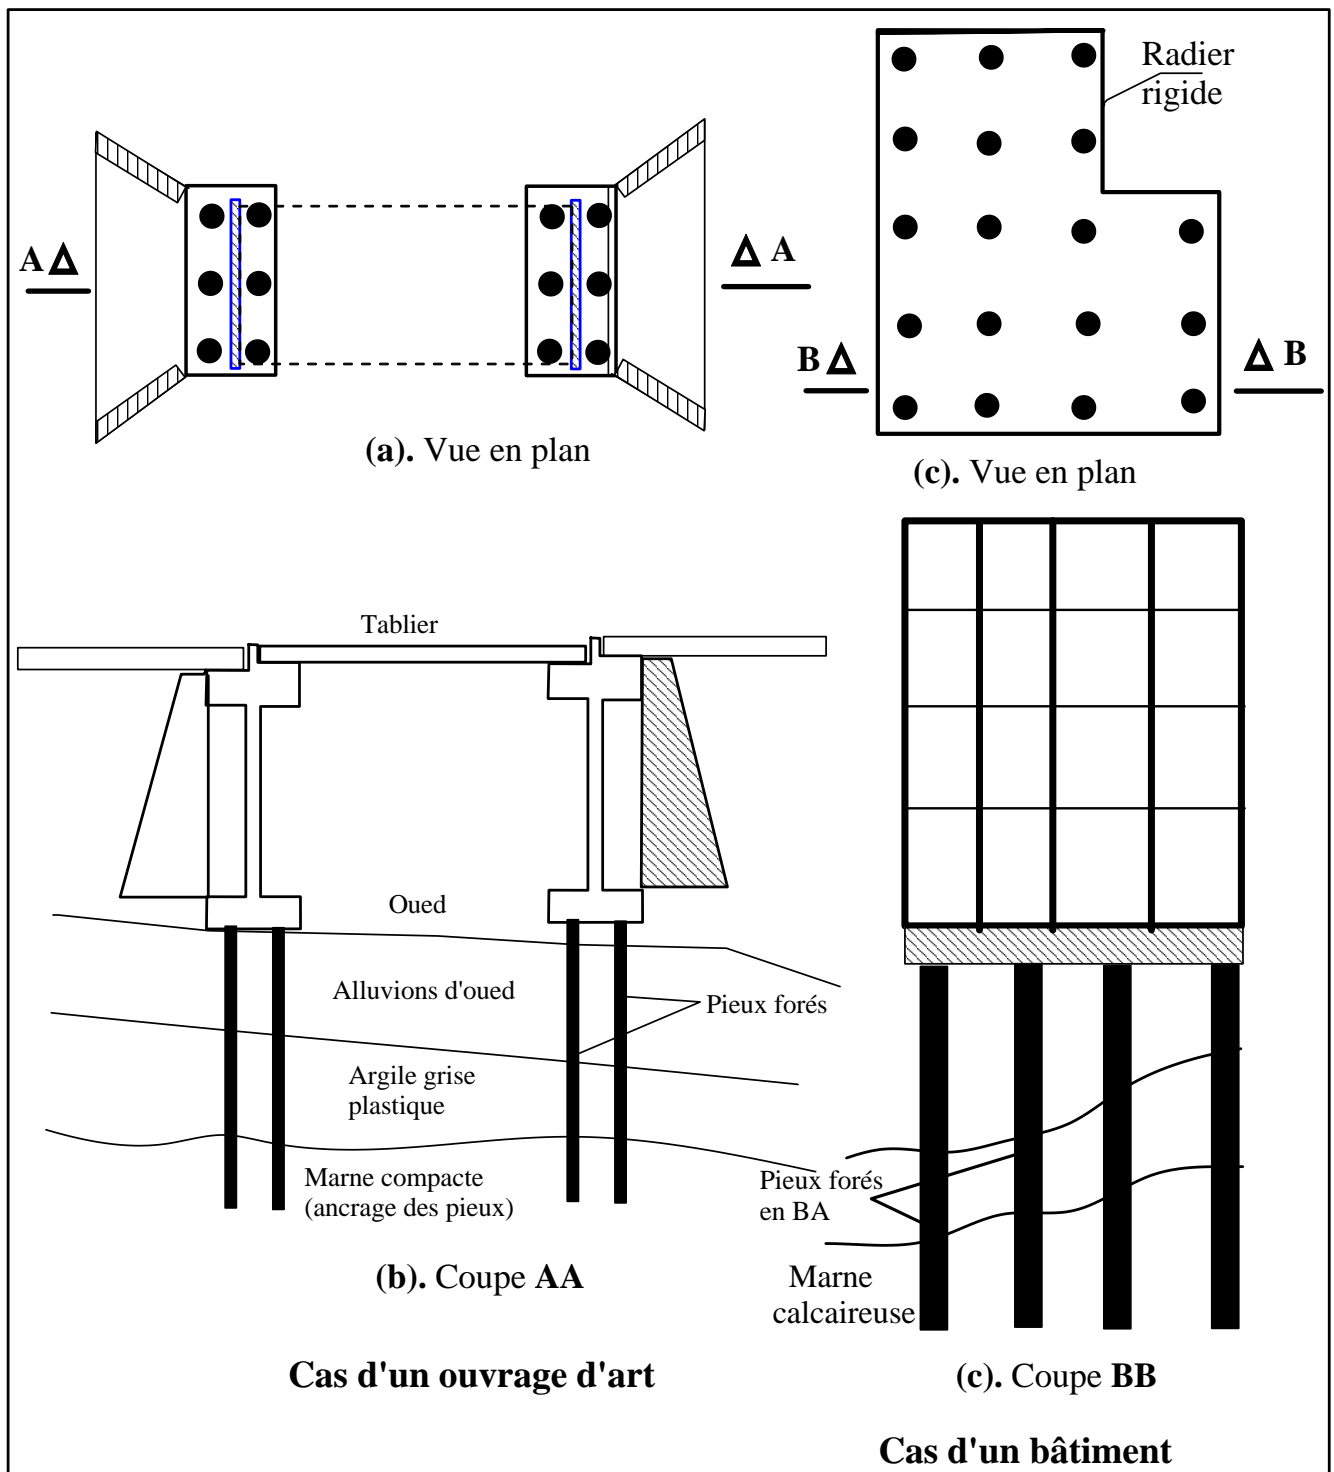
Ouvrages (pont et bâtiment) sur pieux.
